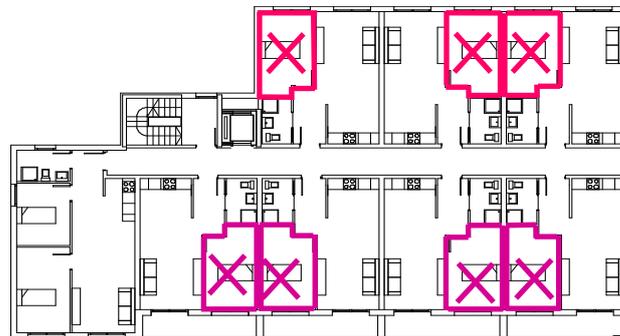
Planta tipo del edificio. Posibles recintos medidas de aislamiento frente ruido exterior
